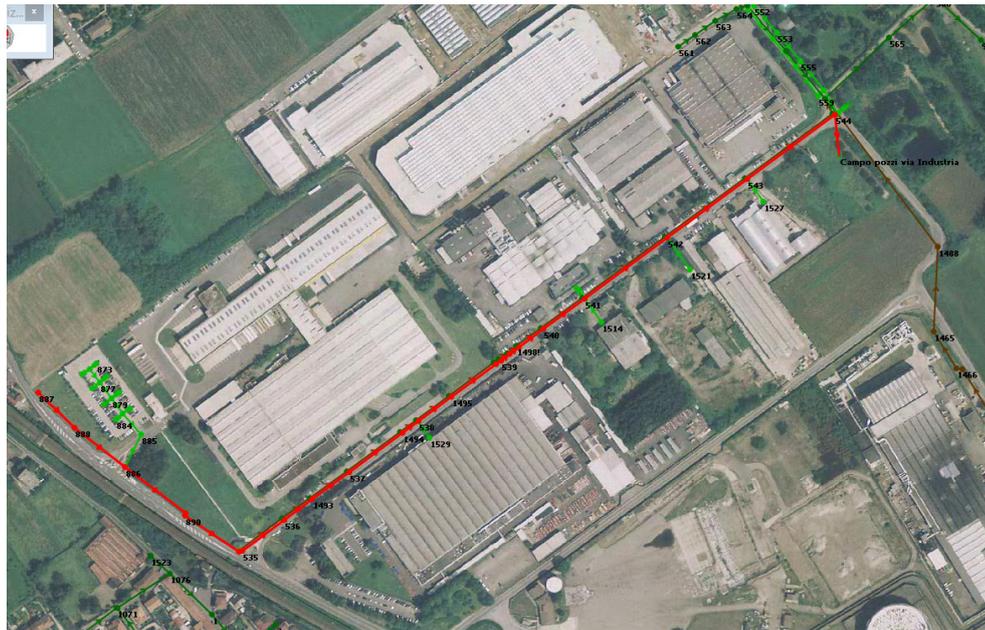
Planimetria rete meteorica di via Vanzago, via delle Industrie e via Castellazzo
